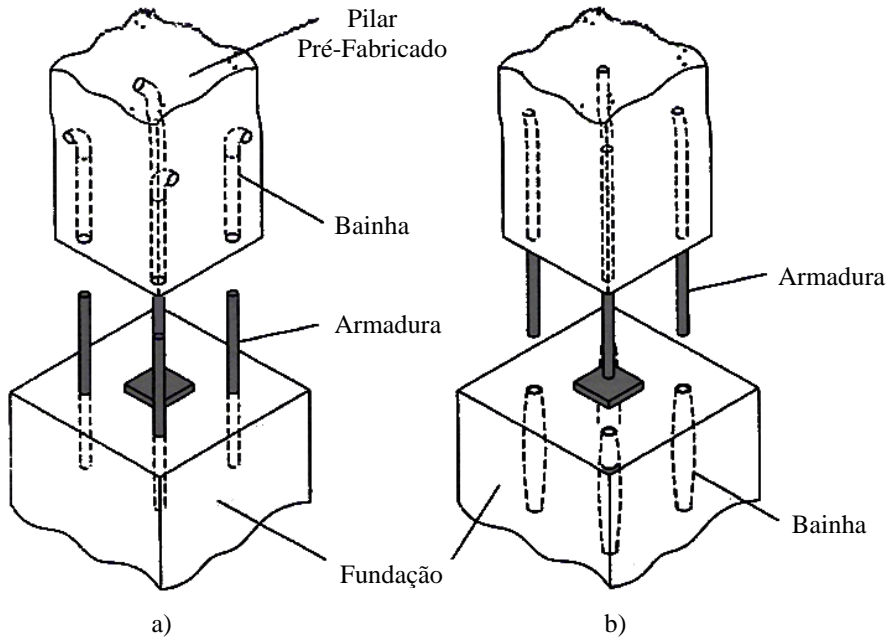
Ligação pilar - fundação com armadura saliente: a) da fundação, b) do pilar, adaptado de [7]
